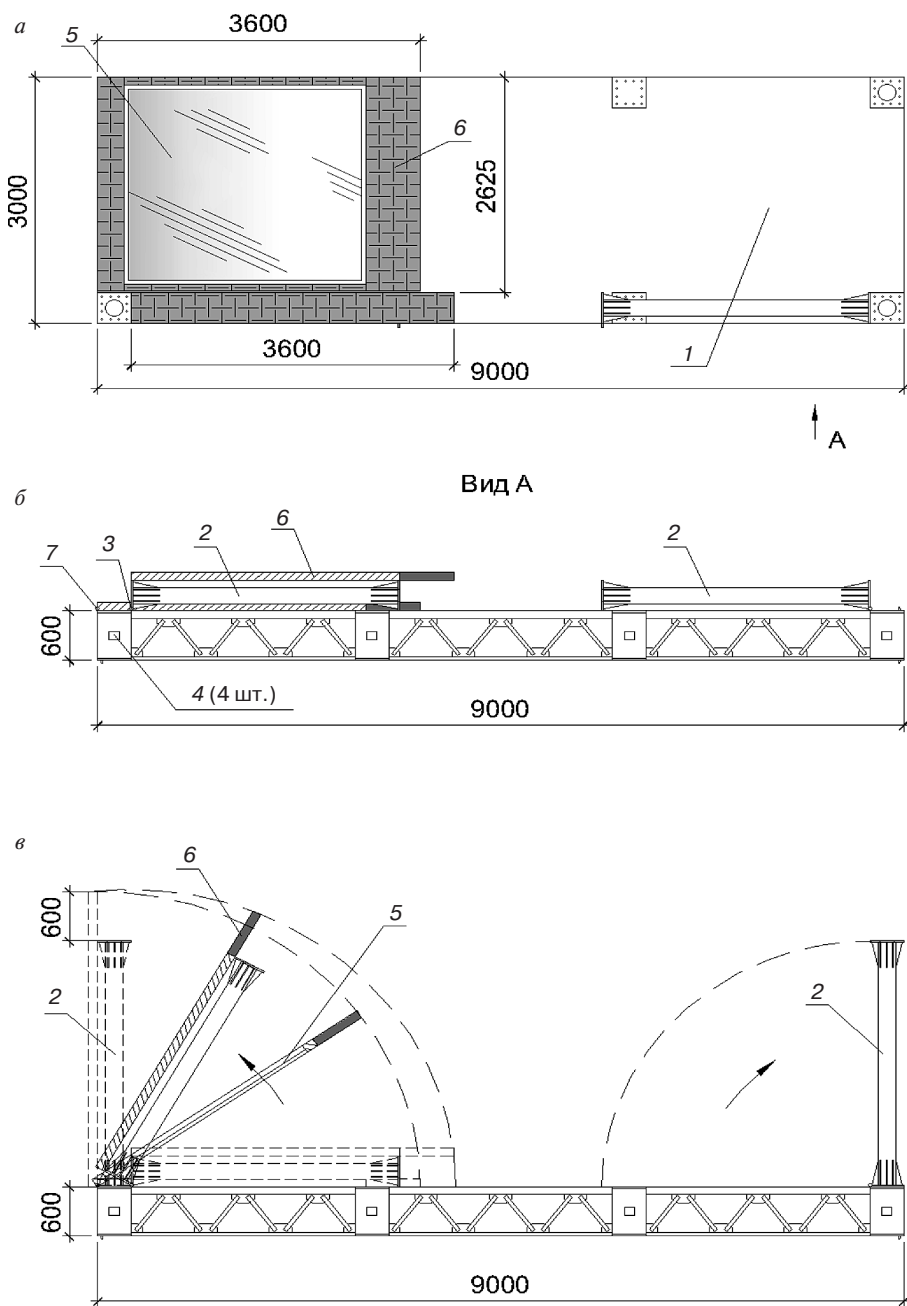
Пример модуля с трансформируемым стеновым ограждением (а) в транспортном (б) и разложенном (в) положениях: 1 – модуль перекрытия; 2 – колонна; 3 – разъемные петли трансформируемой колонны; 4 – дополнительные крепежи для наружных стеновых ограждений; 5 – двухкамерный стеклопакет; 6 – простенки с солнечными батареями; 7 – поворотные петли стенового ограждения
